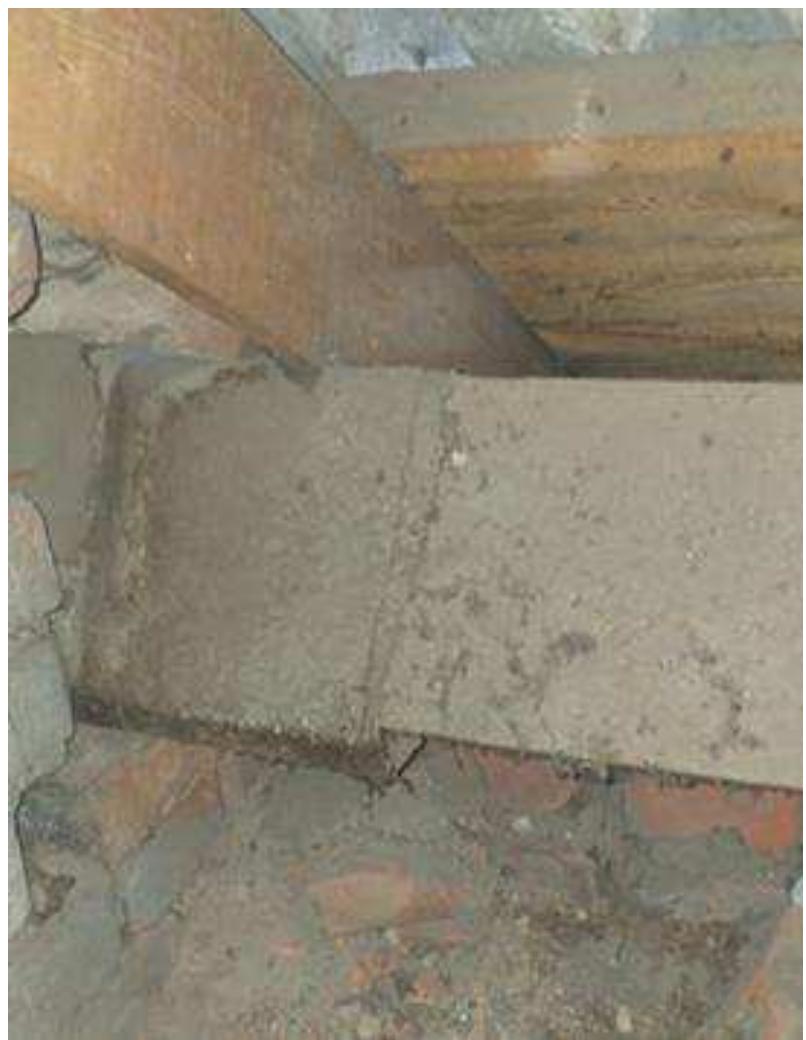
Из-за неудовлетворительного ремонта кровли выявлены
